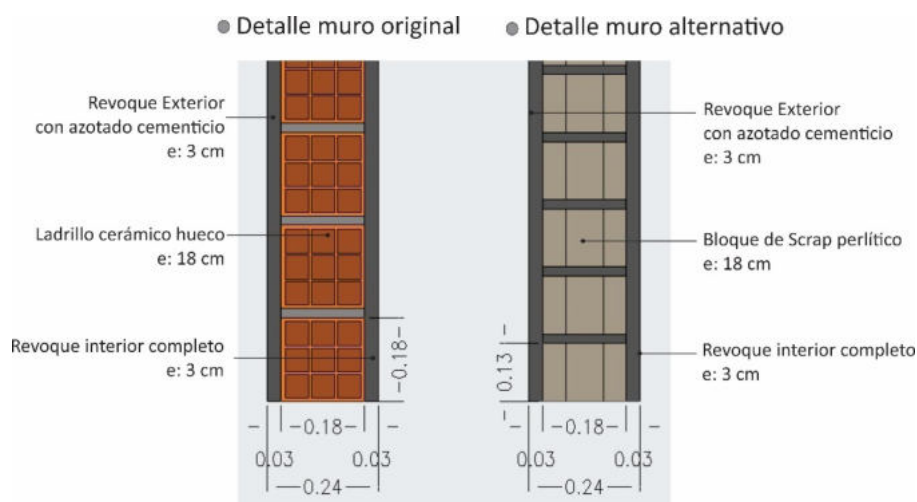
Detalle constructivo de muros analizados – Fuente: Producción propia
